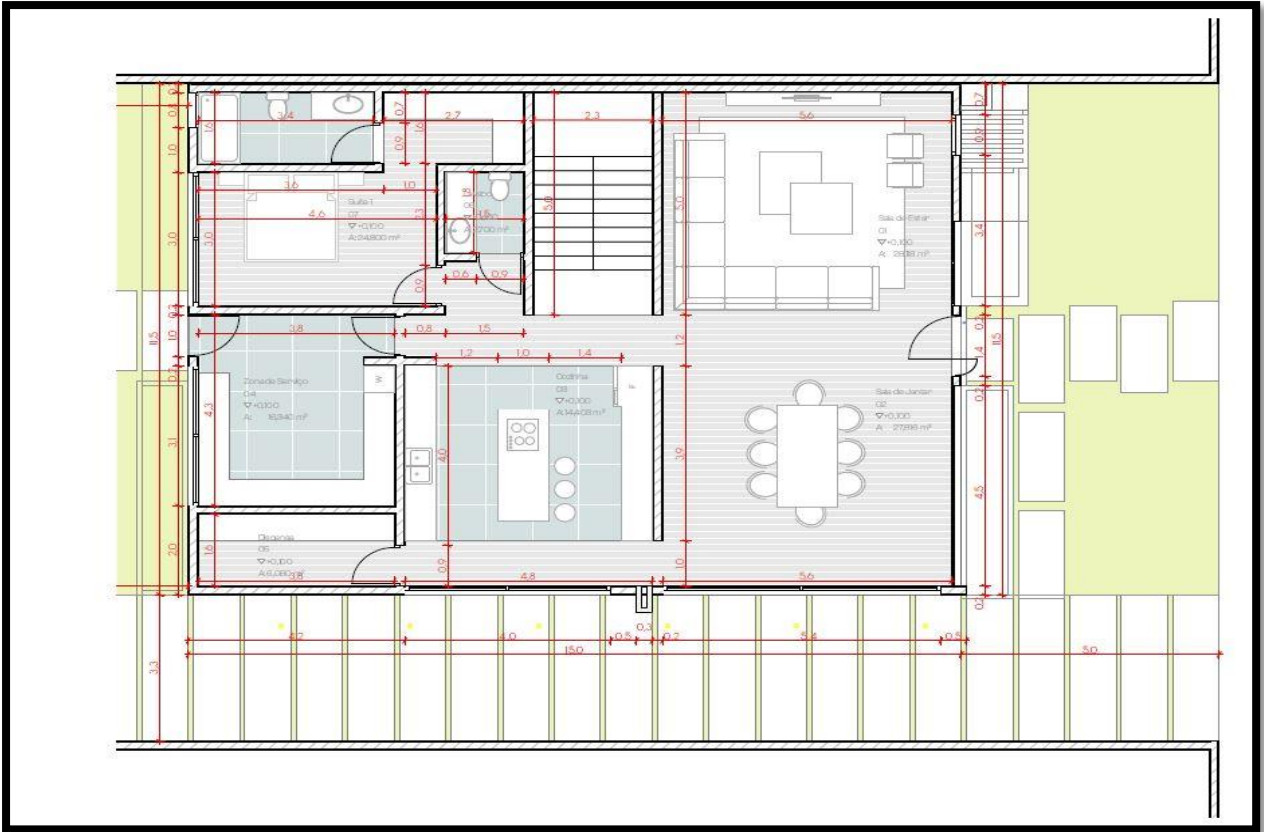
Planta do pavimento térreo. (fonte: Golfo Engenharia e Construções, SA)
